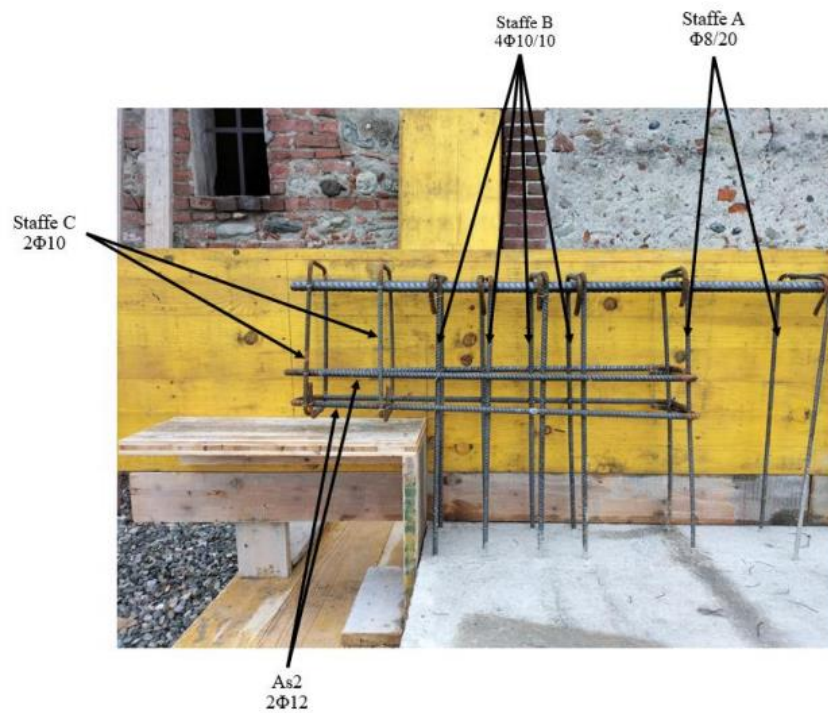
Disposizione armatura: schema A, lato sano [2], [23]
